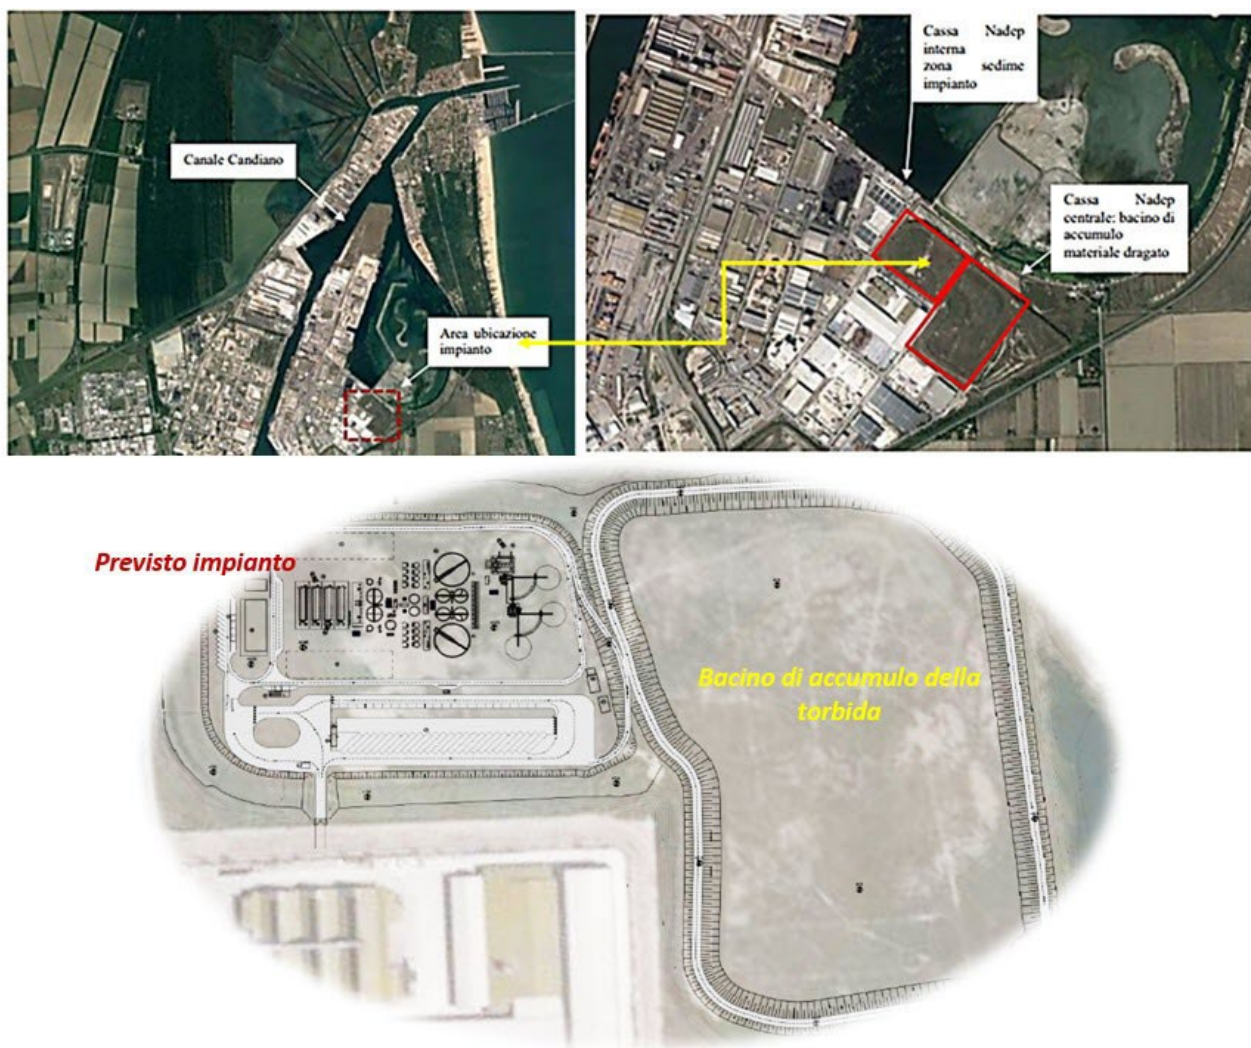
Inquadramento ed ubicazione della zona di previsto progetto nell’ambito portuale ravennate
